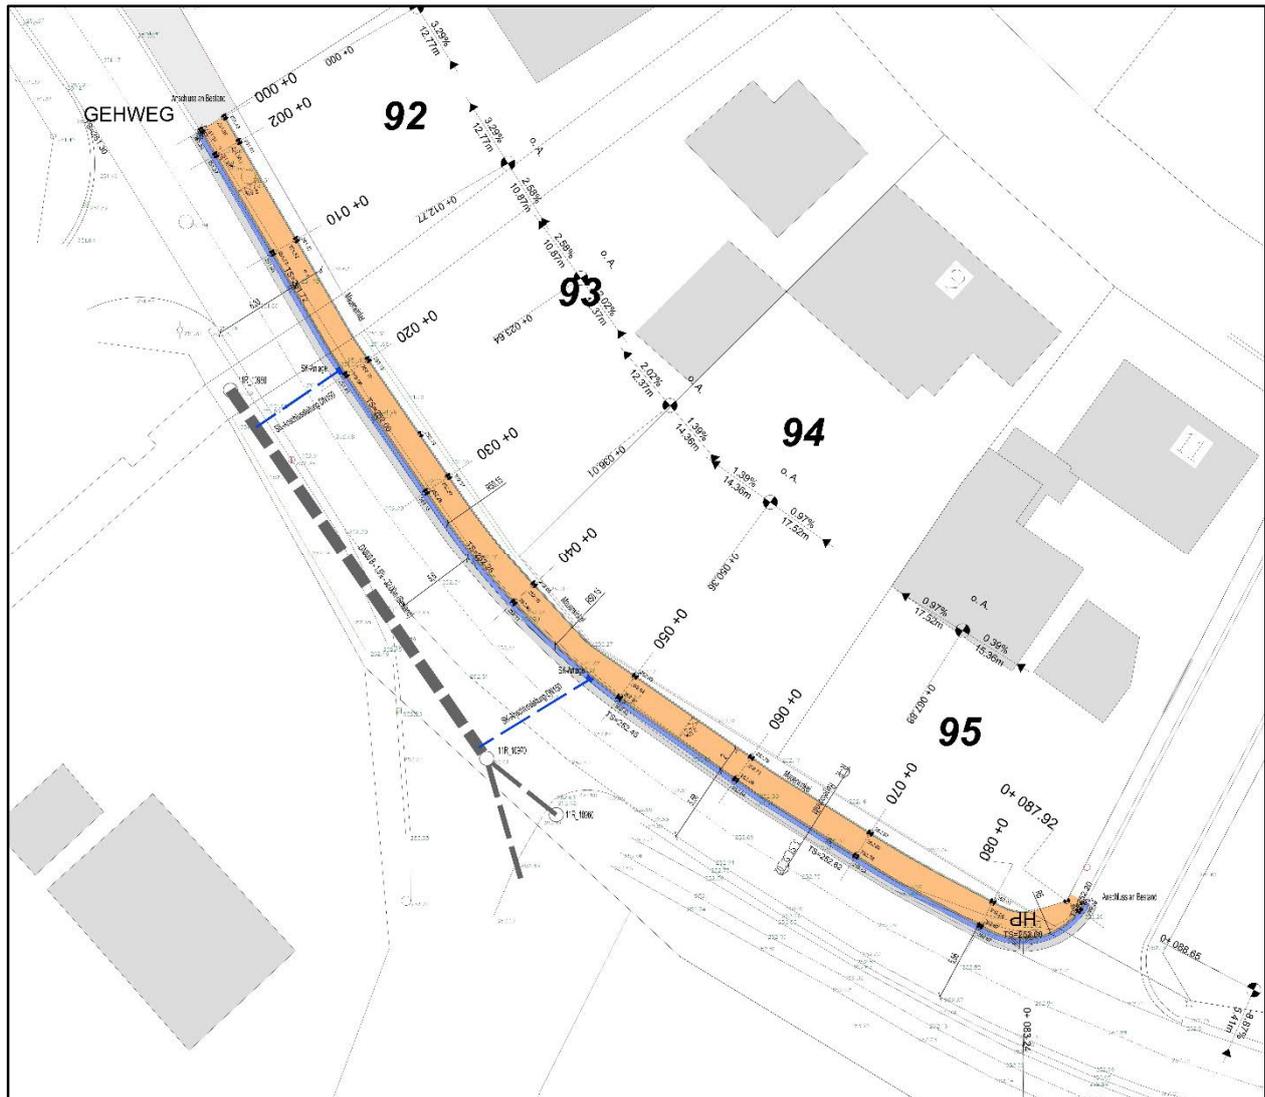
Gehwegeplanung (© plan° D Wiesbaden)
